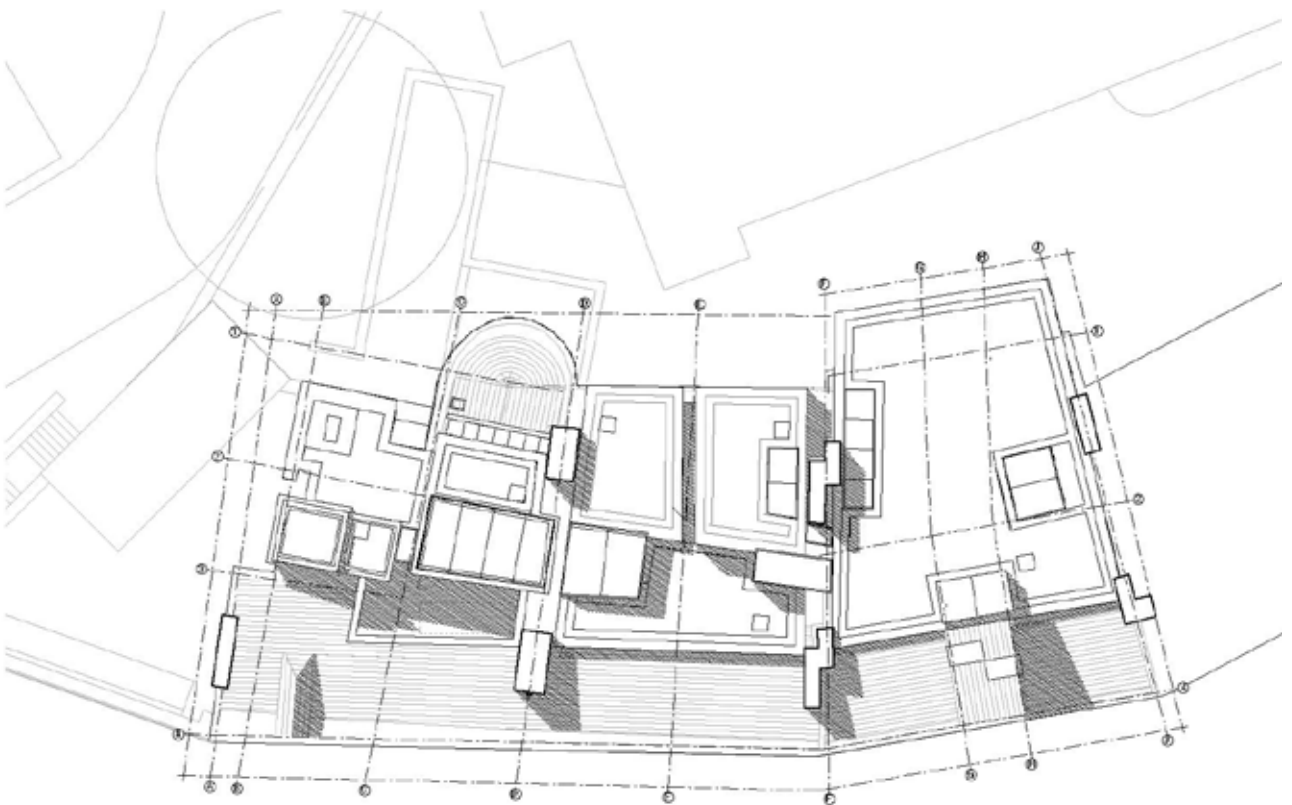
Dachaufsicht © McCollough Mulvin Architects
